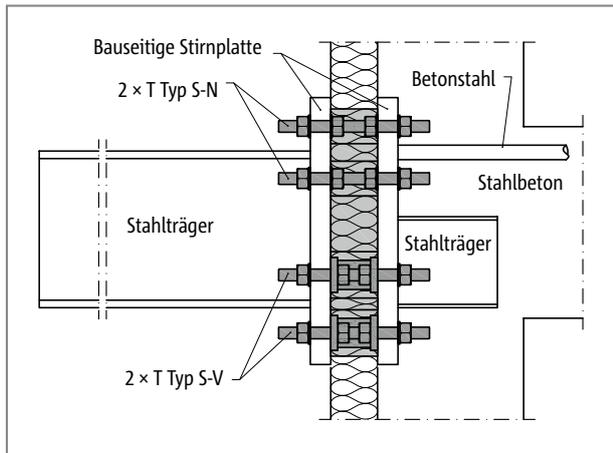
Schöck Isokorb® T Typ S-N und T Typ S-V: Anschluss Stahlkonstruktion an Stahlbeton
